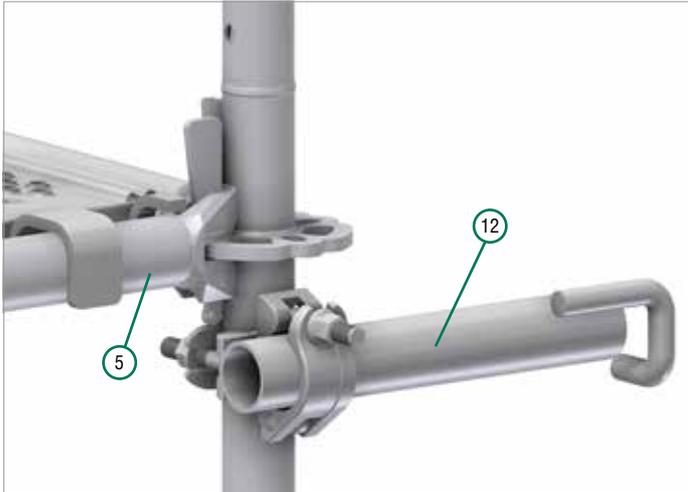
Detail Gerüstknoten mit Auflagerriegel und Gerüstanker
